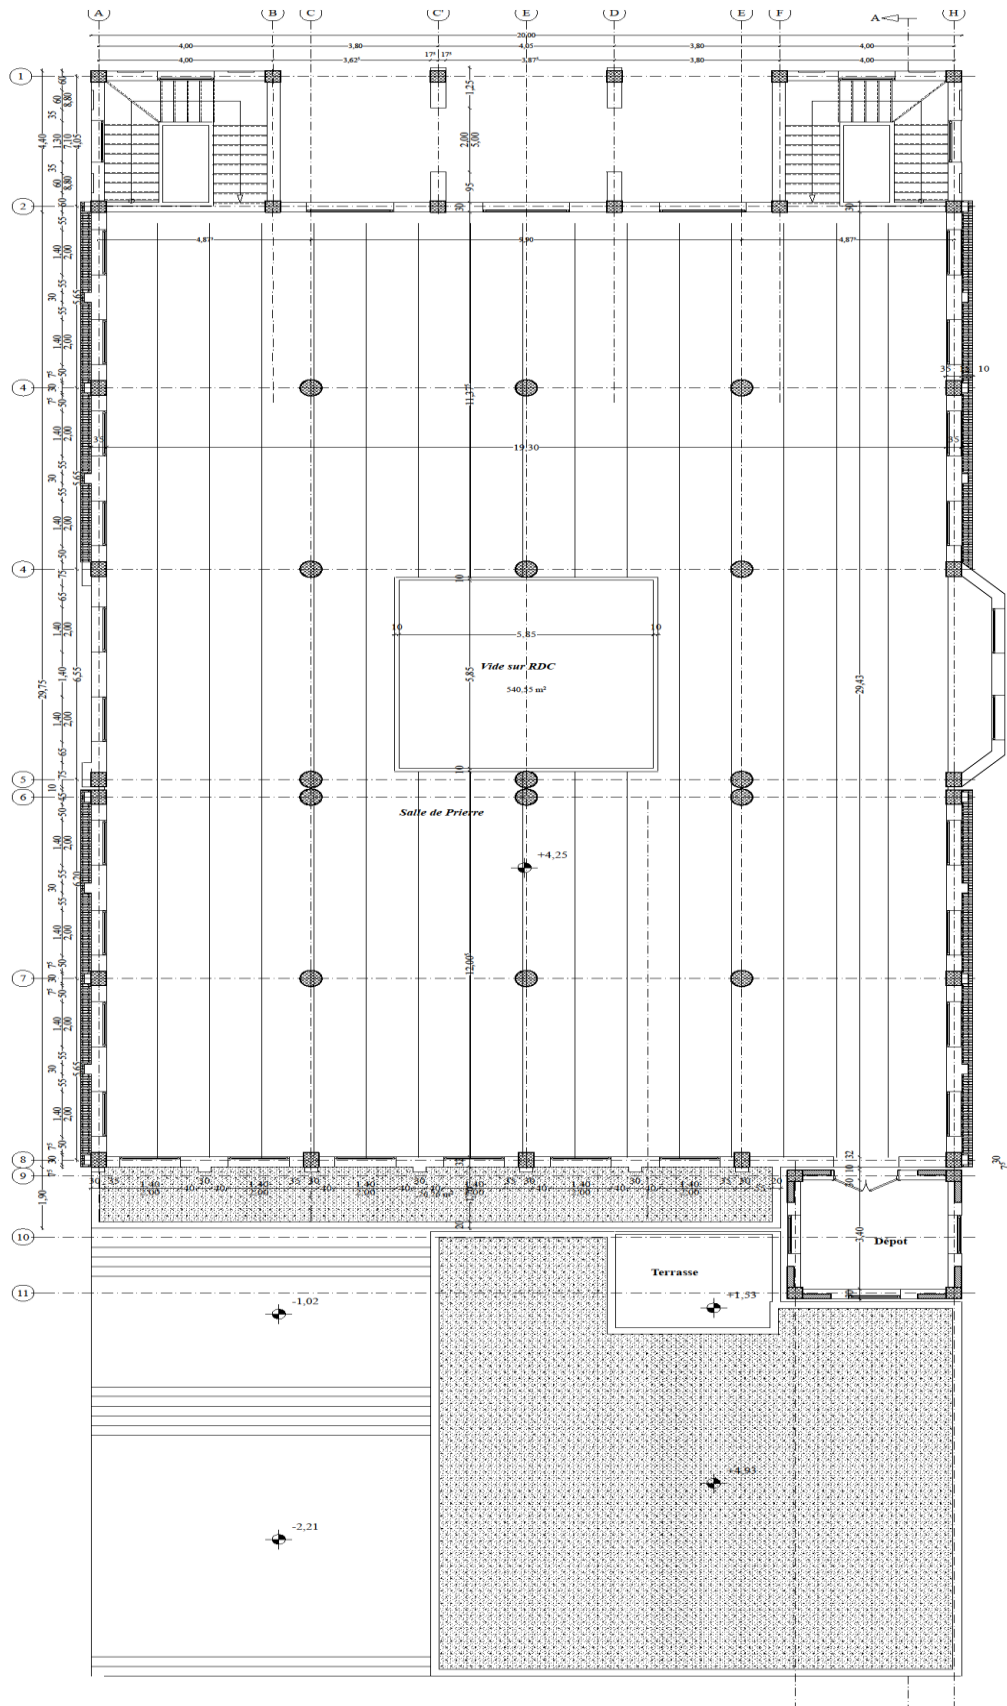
Vue en plan niveaux 1^{er} étage de la structure
